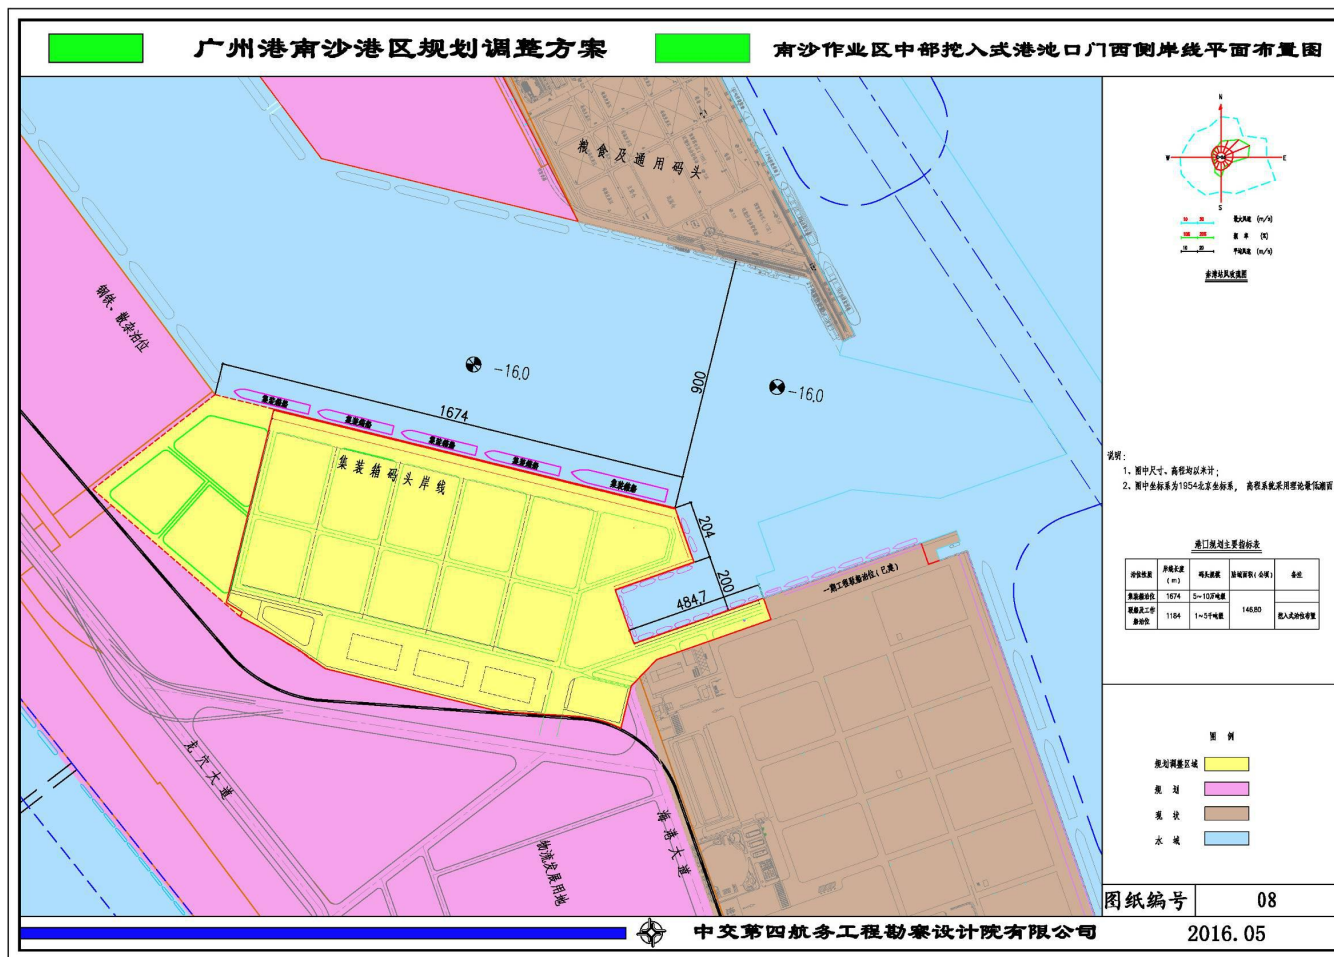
南沙作业区中部挖入式港池口门西侧岸线平面布置图（调整后）
